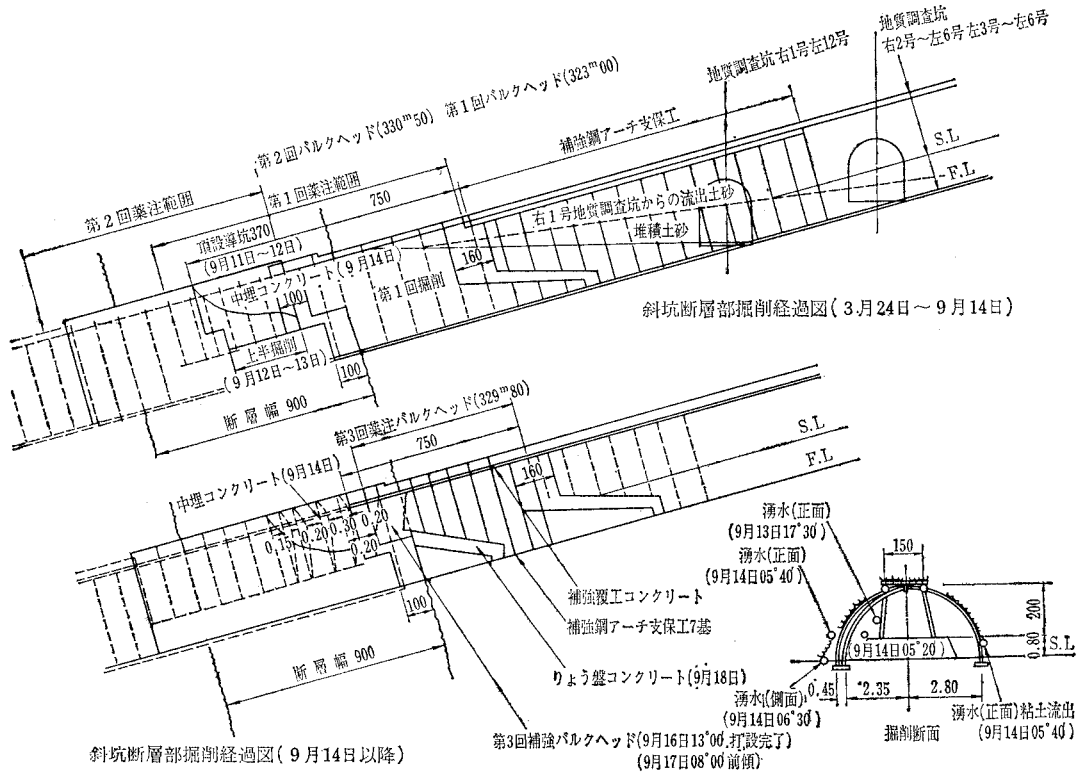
芦屋斜坑 330 m 付近断層破砕帯の施工
